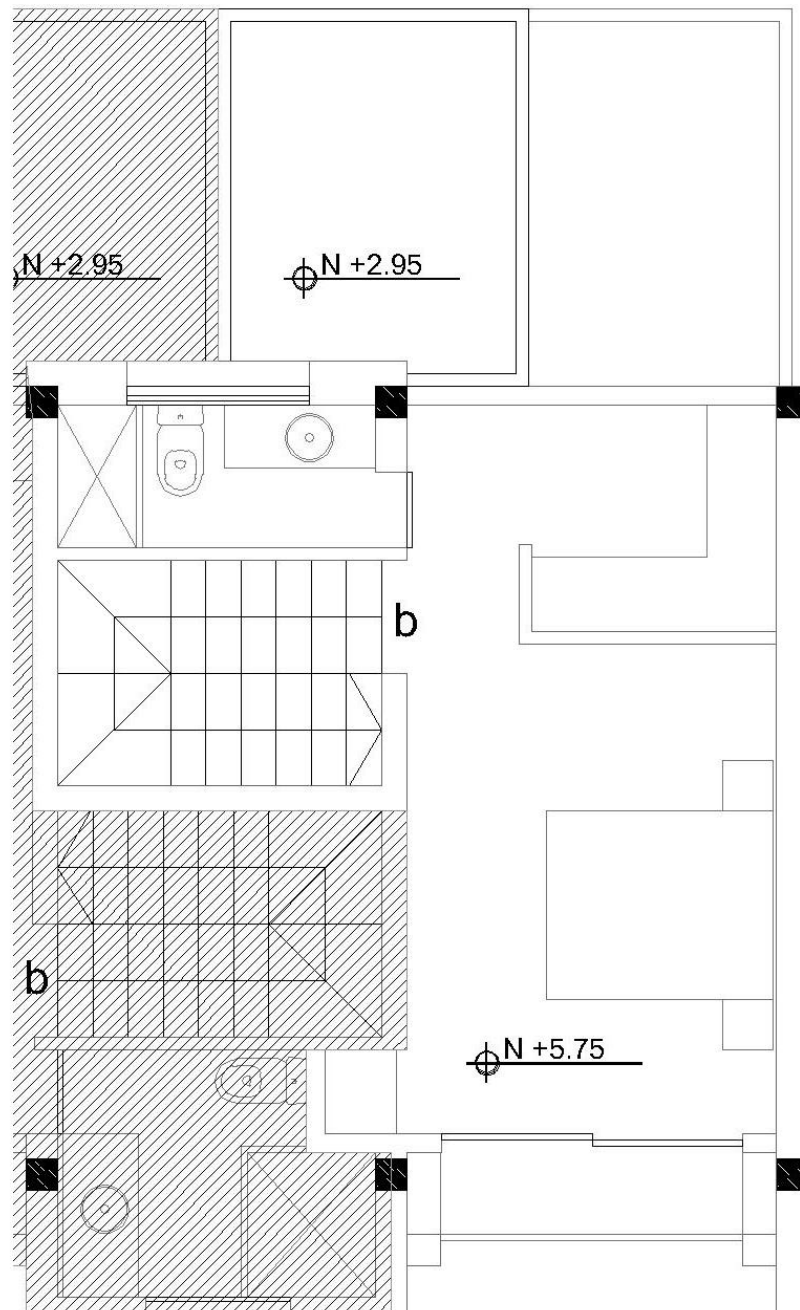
CASA TIPO B – PRIMERA PLANTA
